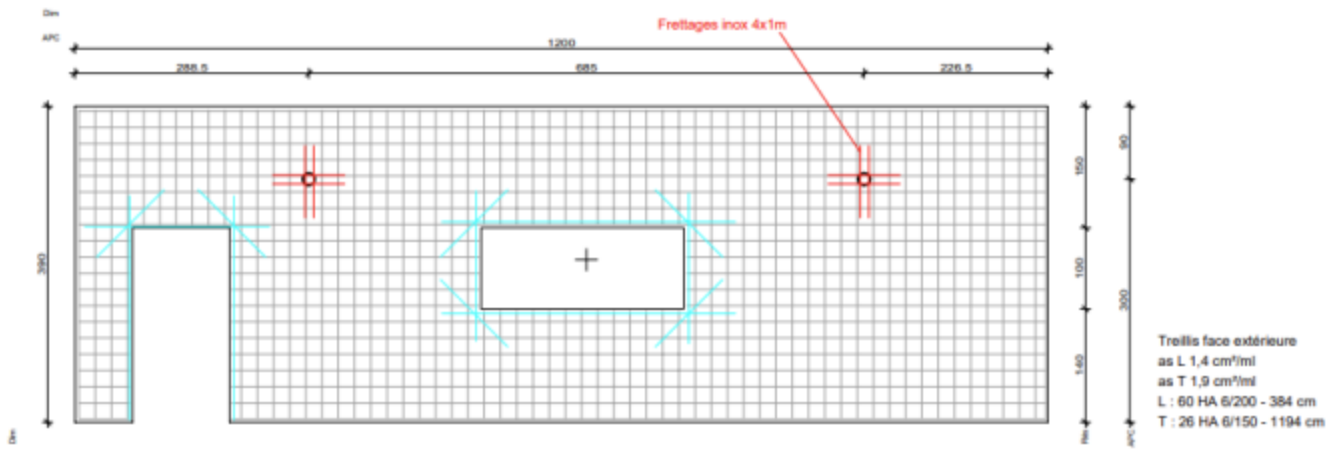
Plan type du BETOMUR RTh Massif type trumeau
